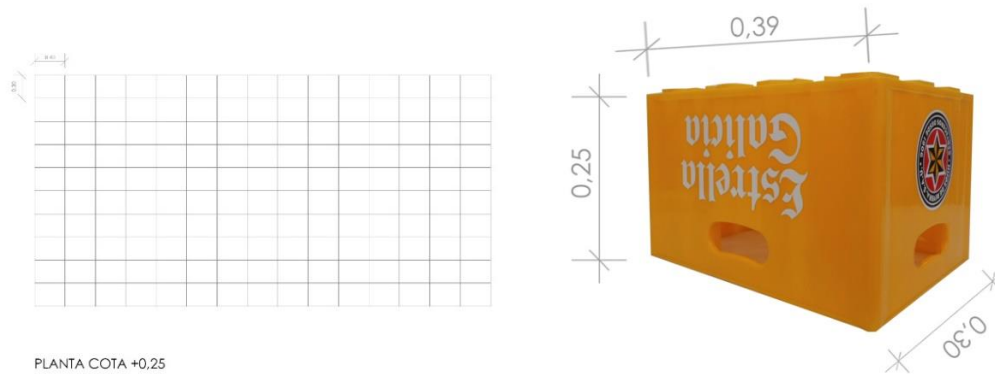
Planta cajas y caja de plástico. Fuente. Elaboración propia.
